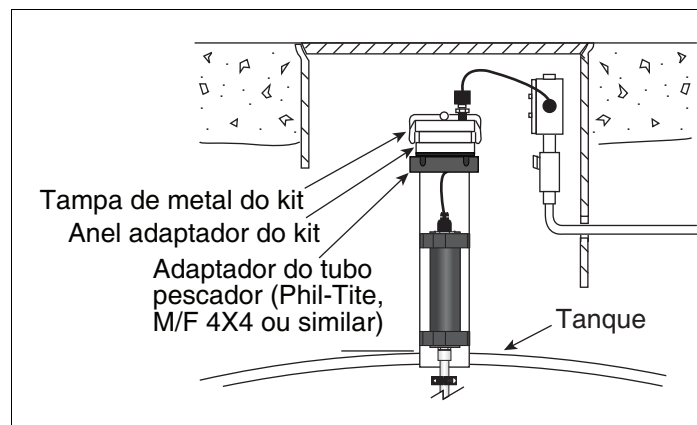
Instalação de um adaptador de tubo pescador sob a tampa de metal e o anel adaptador
